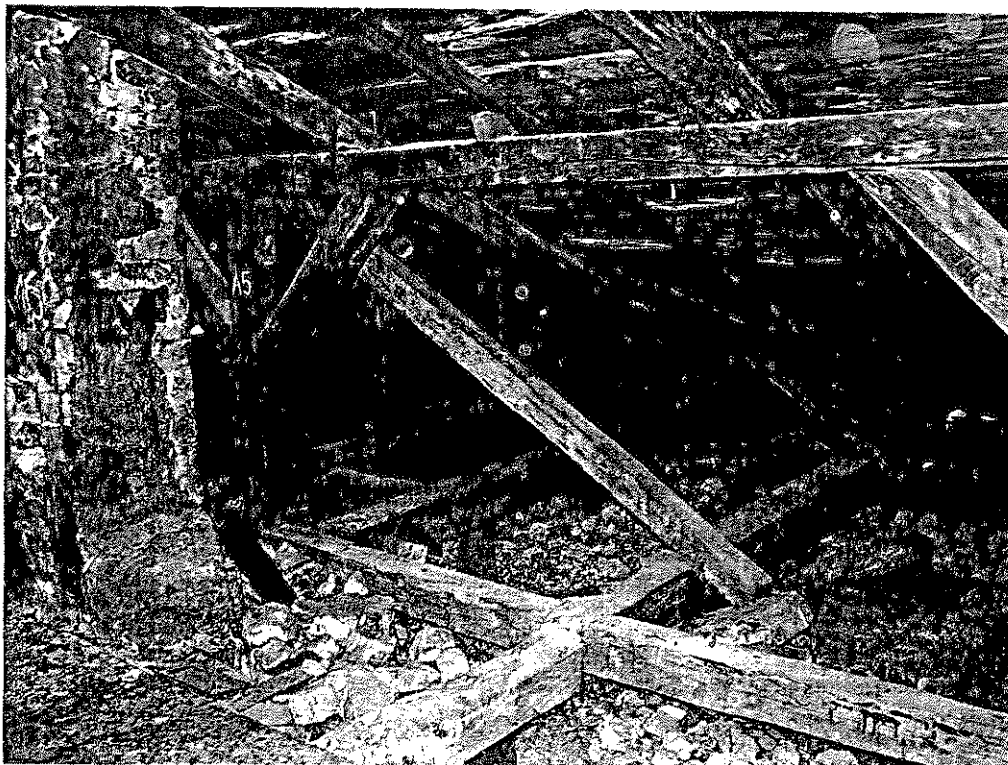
Więźba dachowa przy kominie istniejącym.
